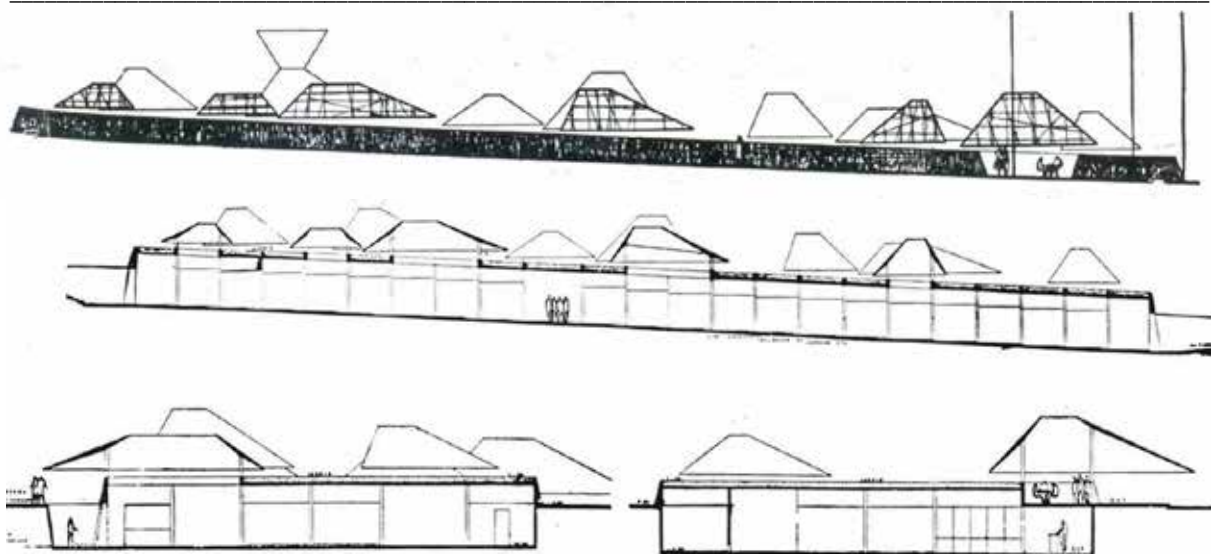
1º prêmio concurso Centro Comercial do Portão: elevação fachada sul.
